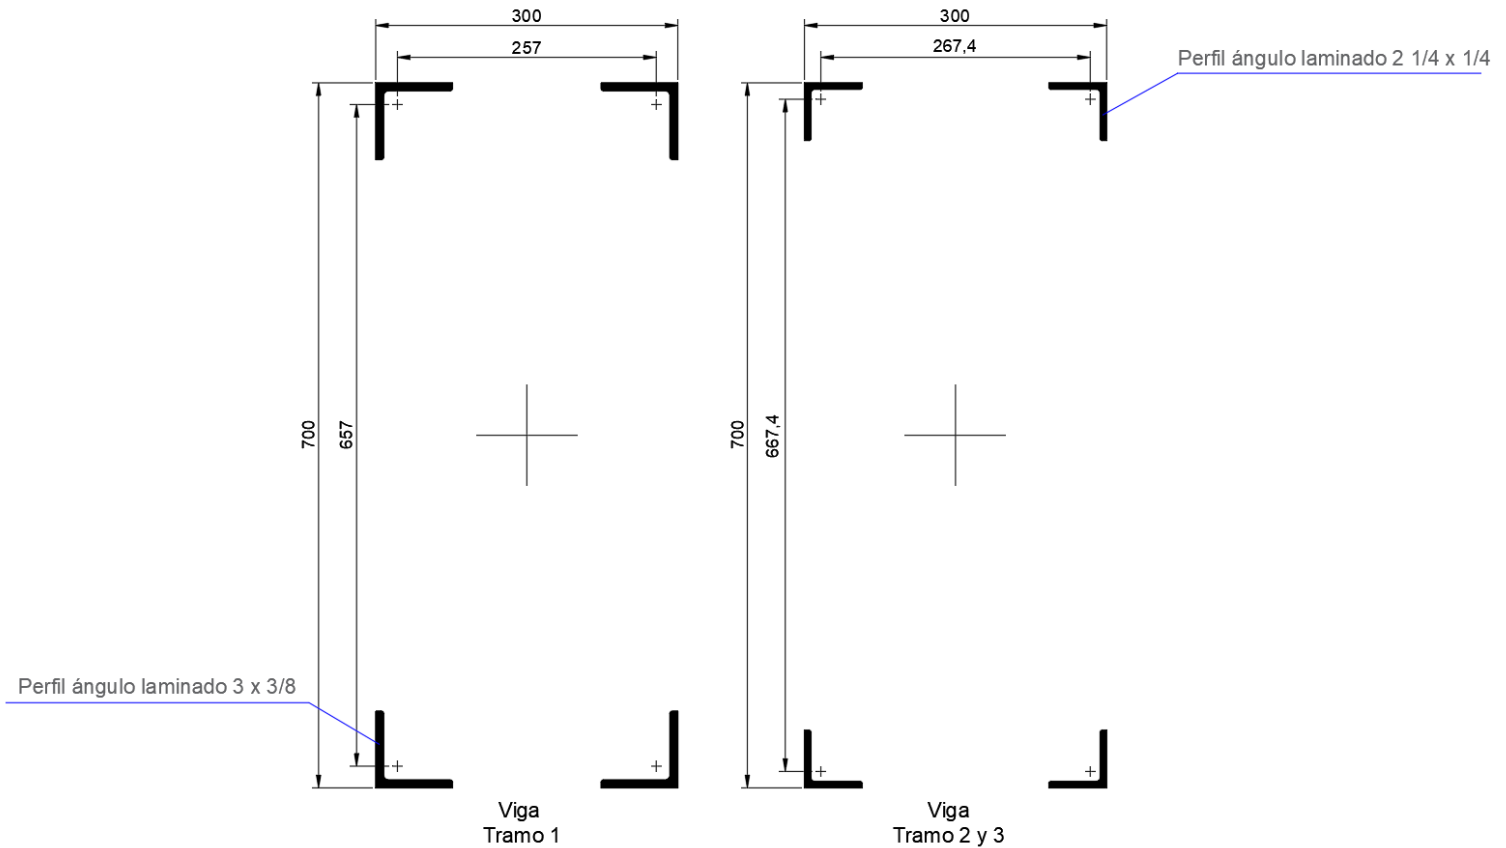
Detalle de secciones de viga para los diferentes tramos
